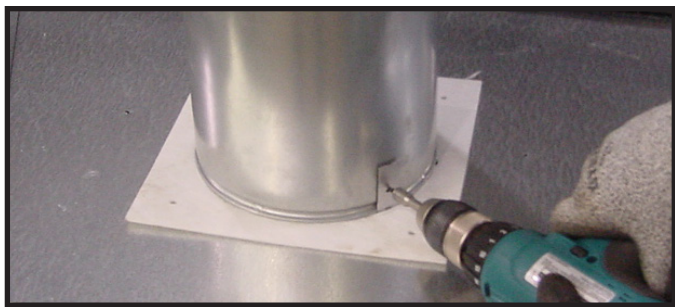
(représentation d'un foyer générique) Pour fixer la première section du conduit d'évacuation, assurez-vous d'utiliser le joint d'étanchéité en fibre de verre se trouvant dans le sac du manuel, pour sceller entre le premier composant et l'enveloppe extérieure du foyer. Utilisez 2 vis autotaraudeuses pour fixer le joint d'étanchéité à l'enveloppe extérieure.
